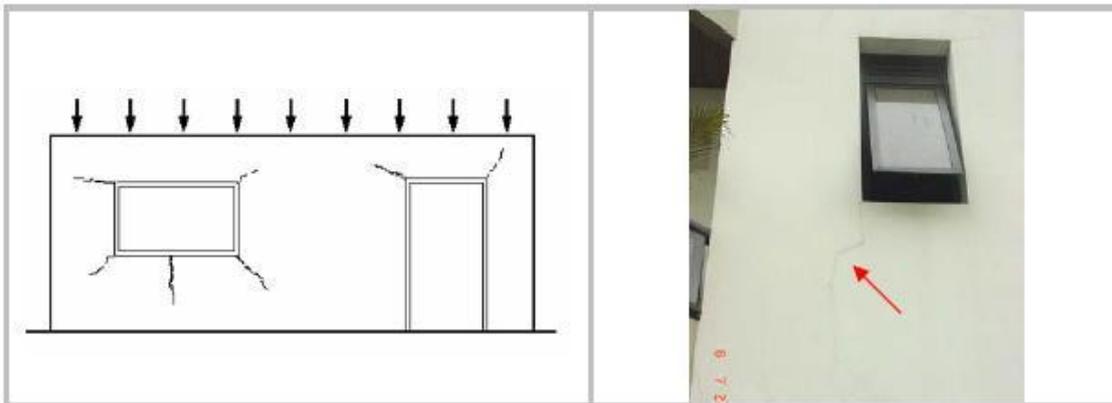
Deformação de vigas e lajes causando fissuras em aberturas
